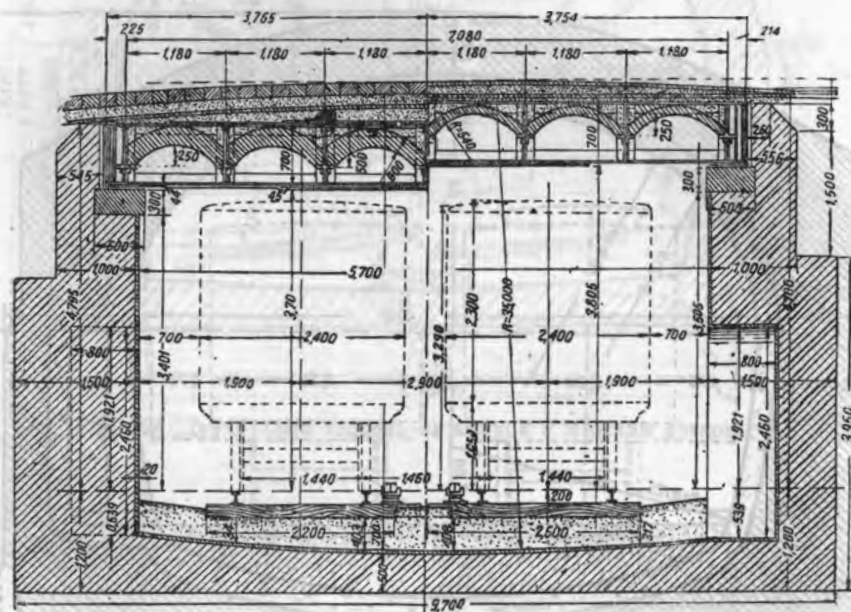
Двухпутный тоннель с металлическим перекрытием.
